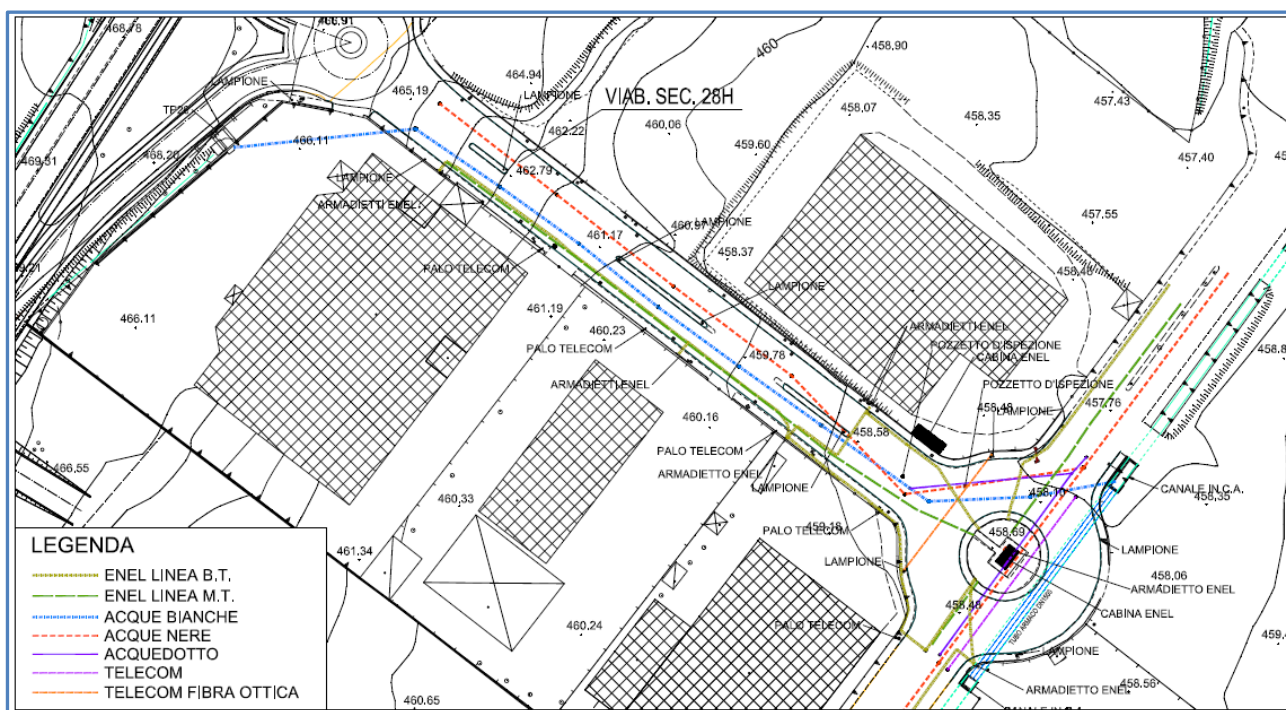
Stralcio planimetrico viabilità secondaria 28H
